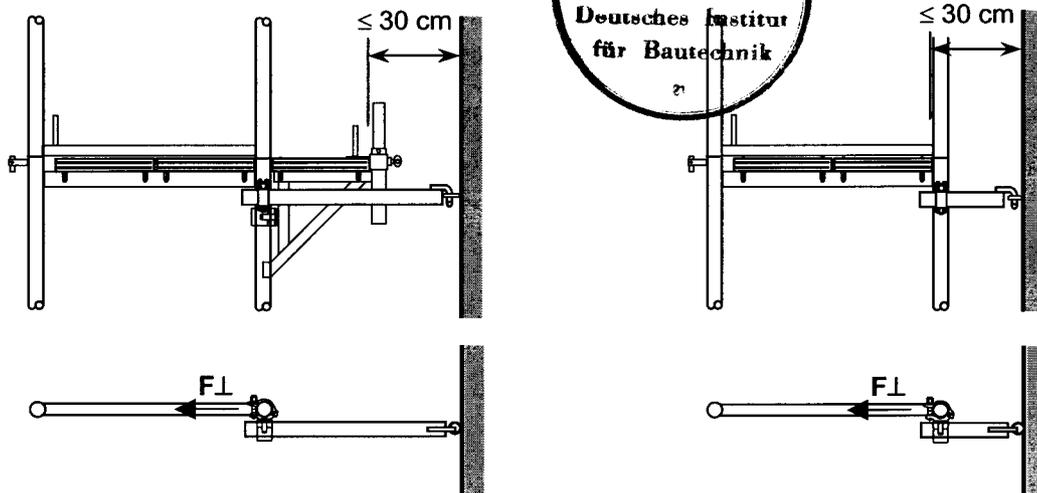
Höhenlage der Gerüsthalter bei Anschluss im „Knoten“.
